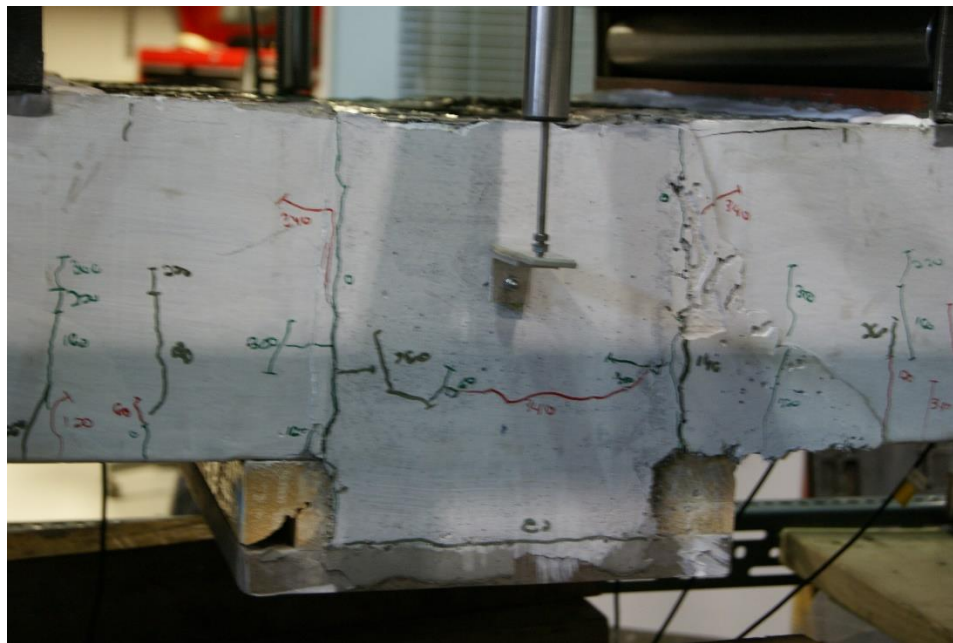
Fissuration au niveau du joint du spécimen avec un chevauchement complet (S5-R)
